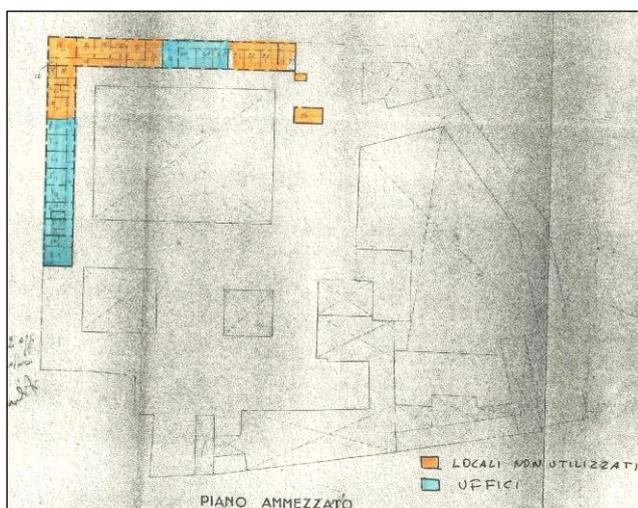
Min. Difesa - *Inventario* – Planimetria del piano ammezzato (1939-1944)
